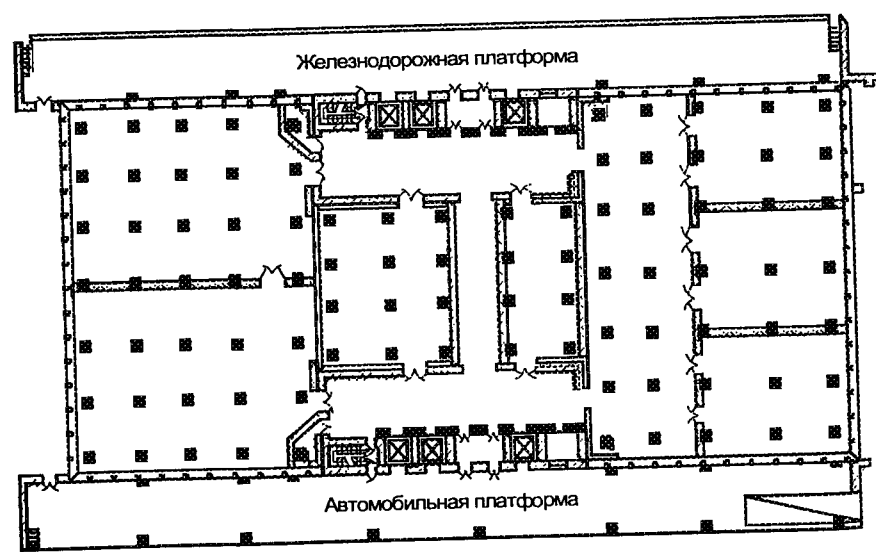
Размещение лестничных клеток у наружных стен здания холодильника
